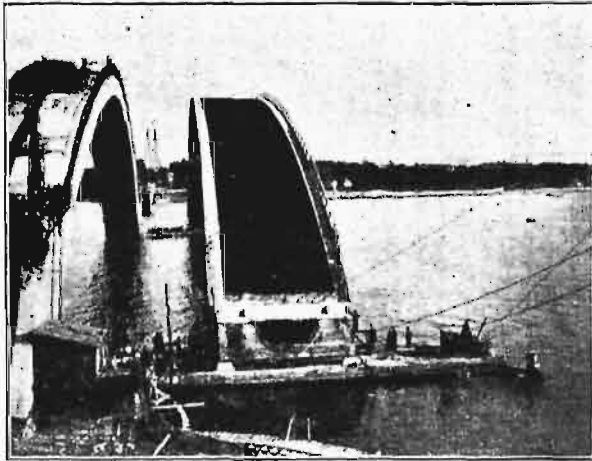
Betonowanie pierwszego łuku na prowizorycznym łuku drewnianym. (U góry widoczne są wózki o napędzie elektrycznym, przewożące beton kolejką linową.)
